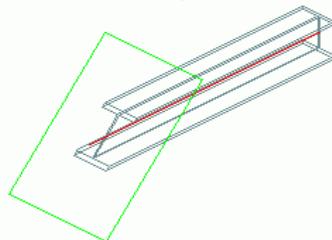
Poutre ajustée sur plan incliné a son extrémité
